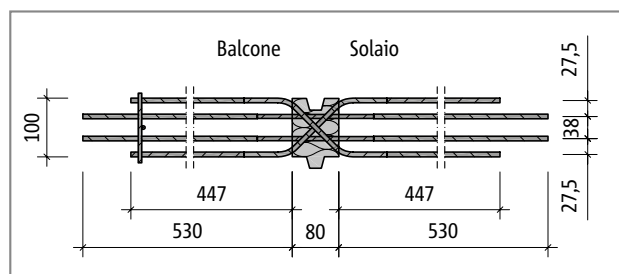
Schöck Isokorb® tipo EQS, pianta del prodotto
